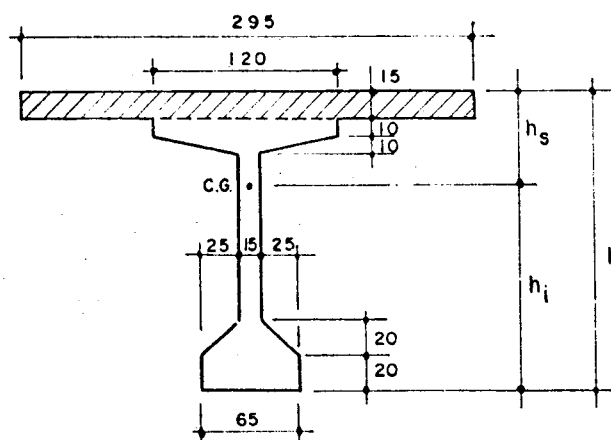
SEÇÃO TRANSVERSAL DA VIGA BI-APOIADA.
